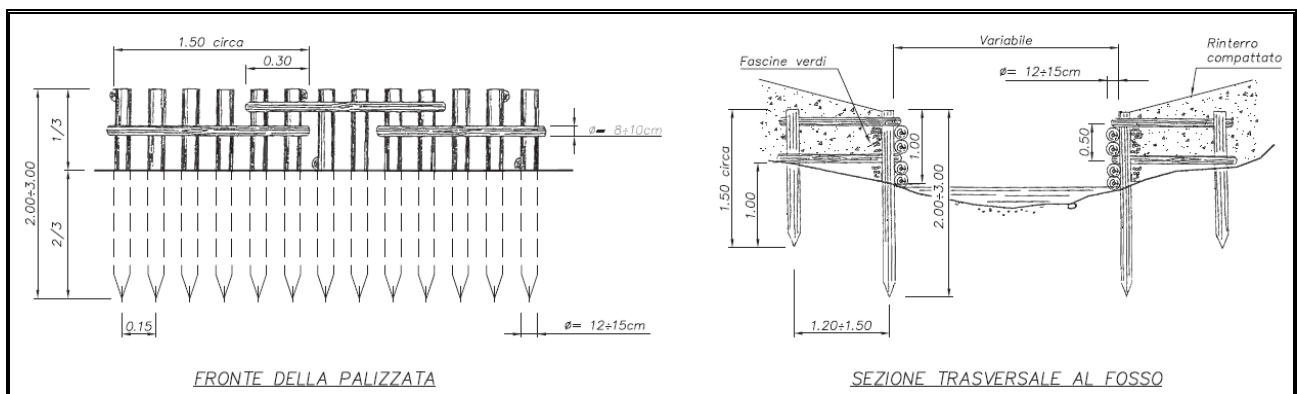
/B: Consolidamento spondale con palizzate (prospetto e sezione).
